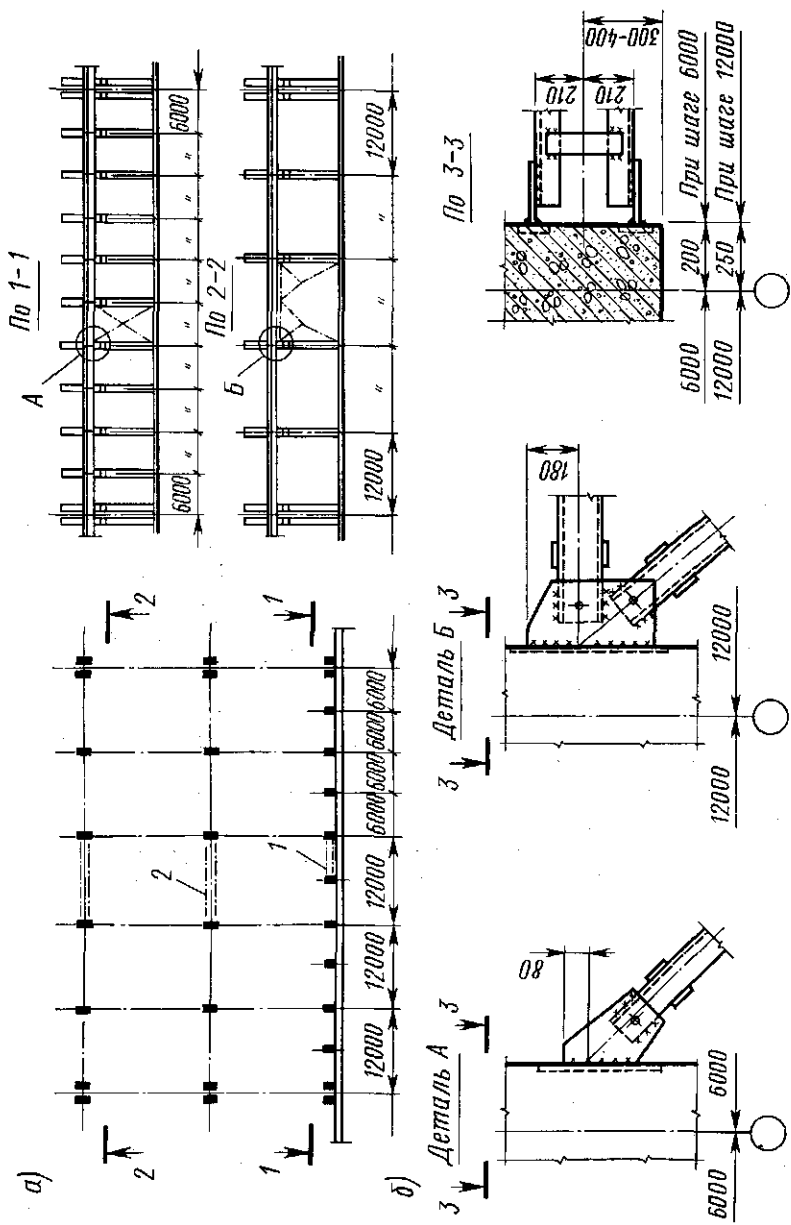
Связи между железобетонными колоннами: а — общий вид; б — детали крепления связей к колоннам; 1 — крестовые связи; 2 — порталные связи
